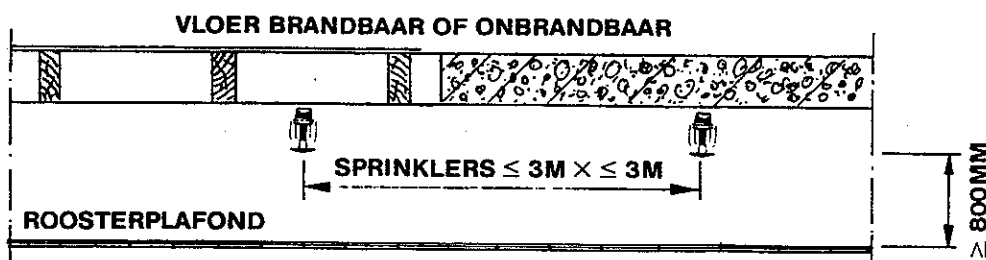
(C) Sprinklers boven open-roosterplafond
